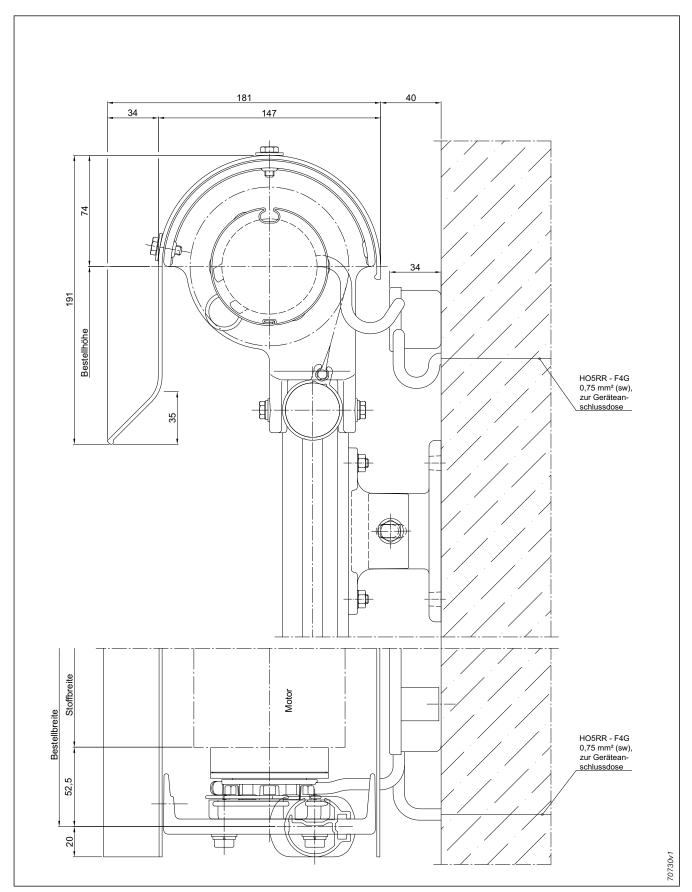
Fassaden-Markise 201 mit Halbrundblende Typ 2.3
